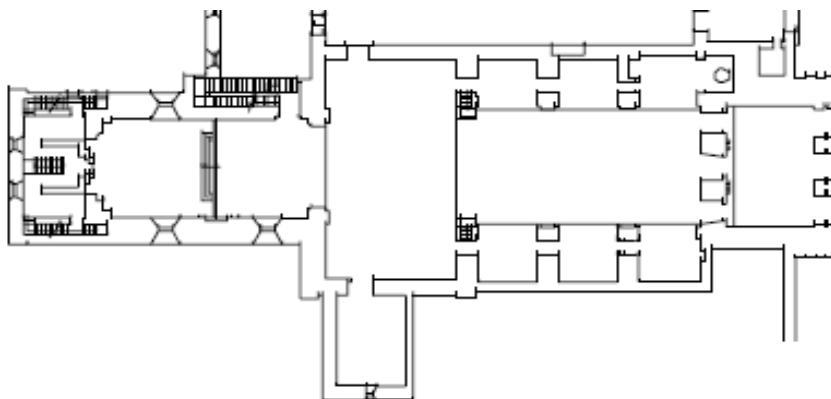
Planta da igreja do mosteiro de Grijó [3]
